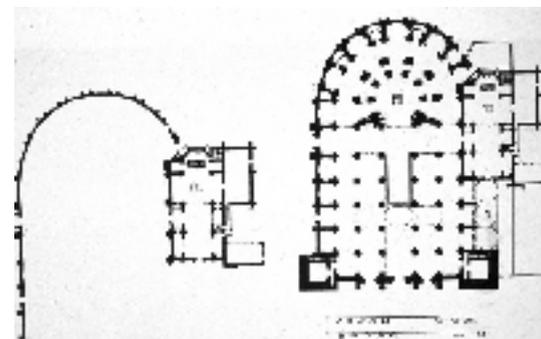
Planta del primer y segundo proyecto de la Catedral de Granada
